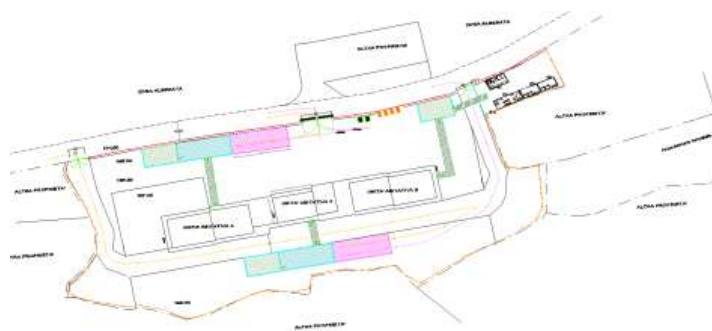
Stralcio del layout di cantiere con indicazione delle vie di circolazione e di transito
